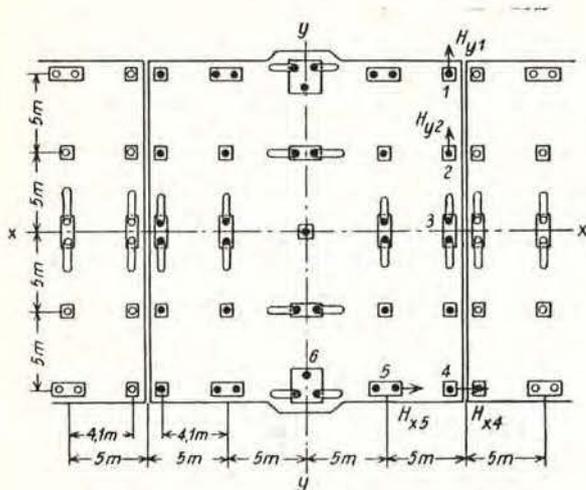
Plans de la fondation sur pieux d'une section du bâtiment.
